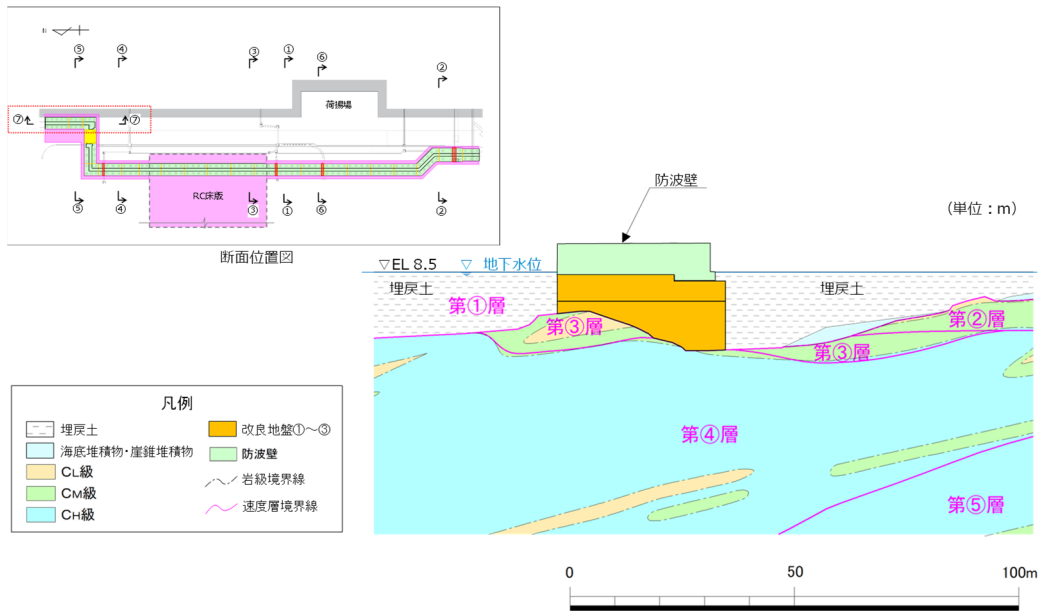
地質断面図 (⑦-⑦断面)
